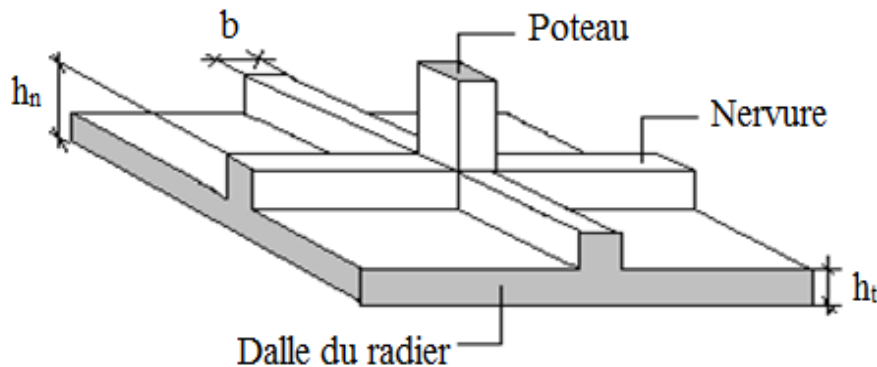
Disposition des nervures par rapport au radier et aux poteaux.
